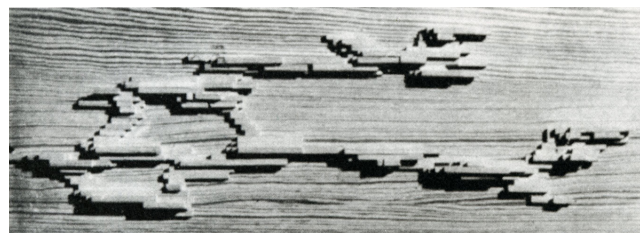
Plano de situación. (Ferrán et al. 1965: 37).
